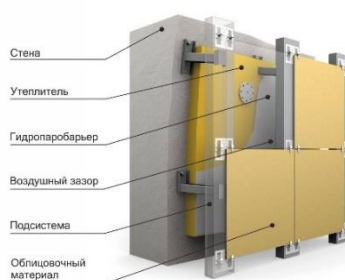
Конструкция и крепление системы вентилируемого фасада «Альтернатива»
